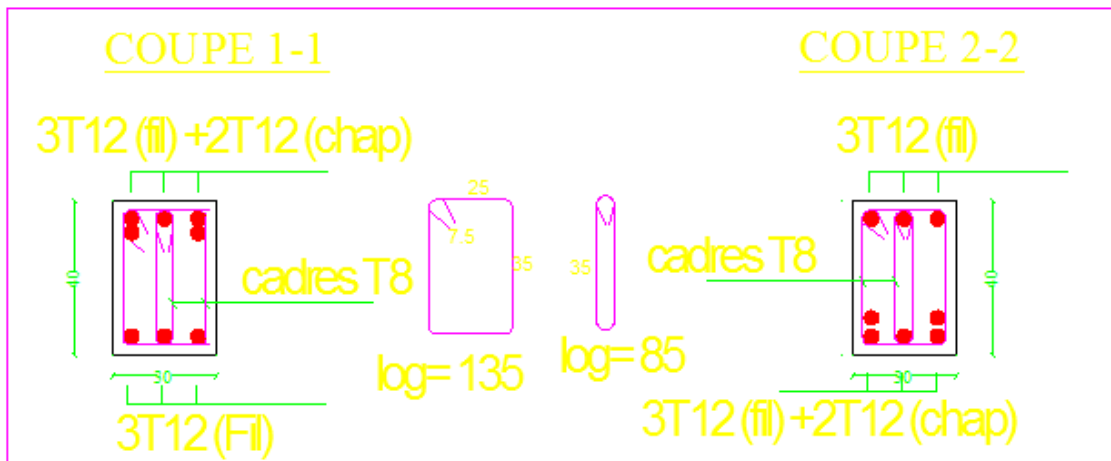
Ferraillage poutres principales non adhéres aux voiles
